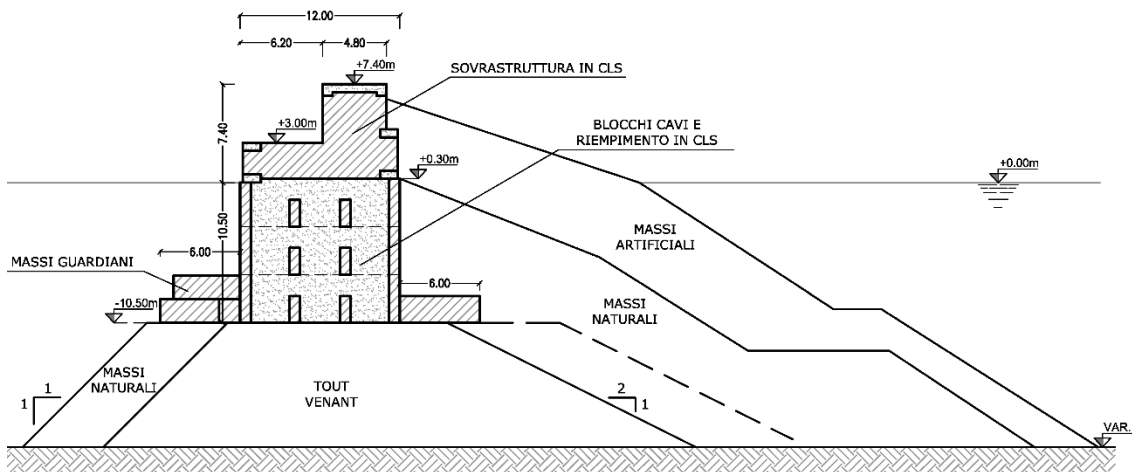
SEZIONE TIPO DEL TRATTO CENTRALE DELLA DIGA ESISTENTE – TRATTO D-E
